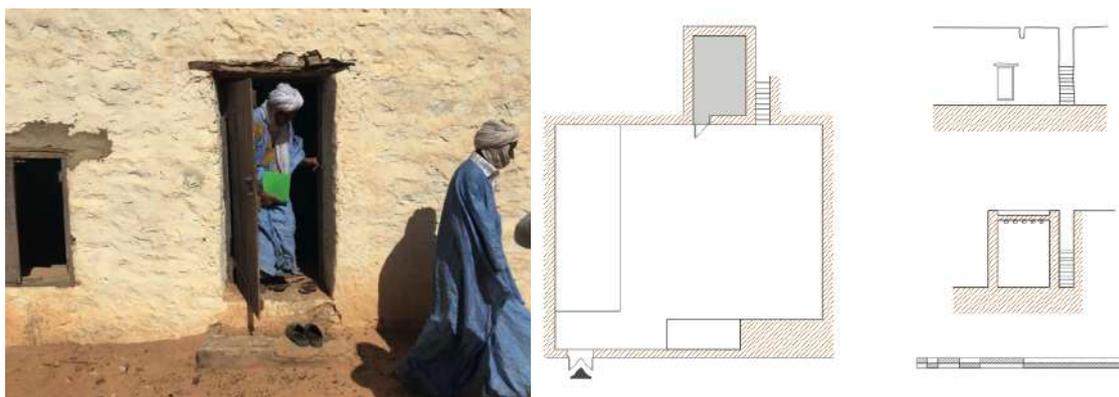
Entrada e levantamento arquitetônico da Biblioteca Hamid. (Terrachidia, 2020)
